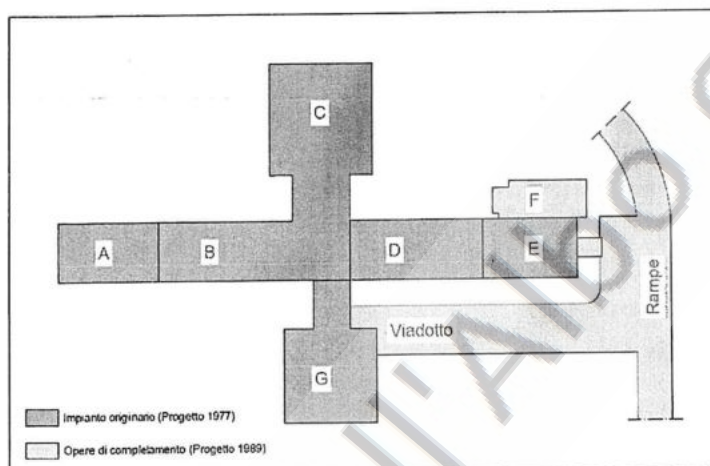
Schema dell'impianto originario e delle opere di completamento
